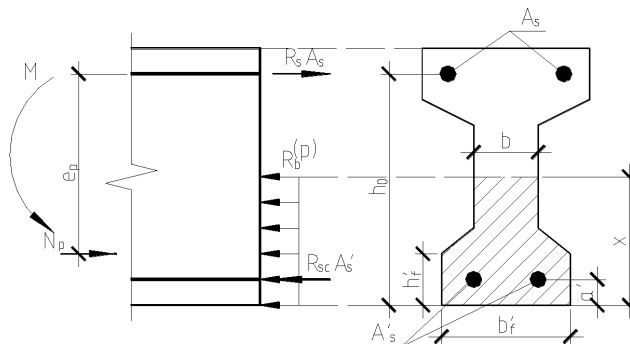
Схема усилий в поперечном сечении железобетонного элемента с полкой в сжатой зоне в стадии предварительного обжатия
